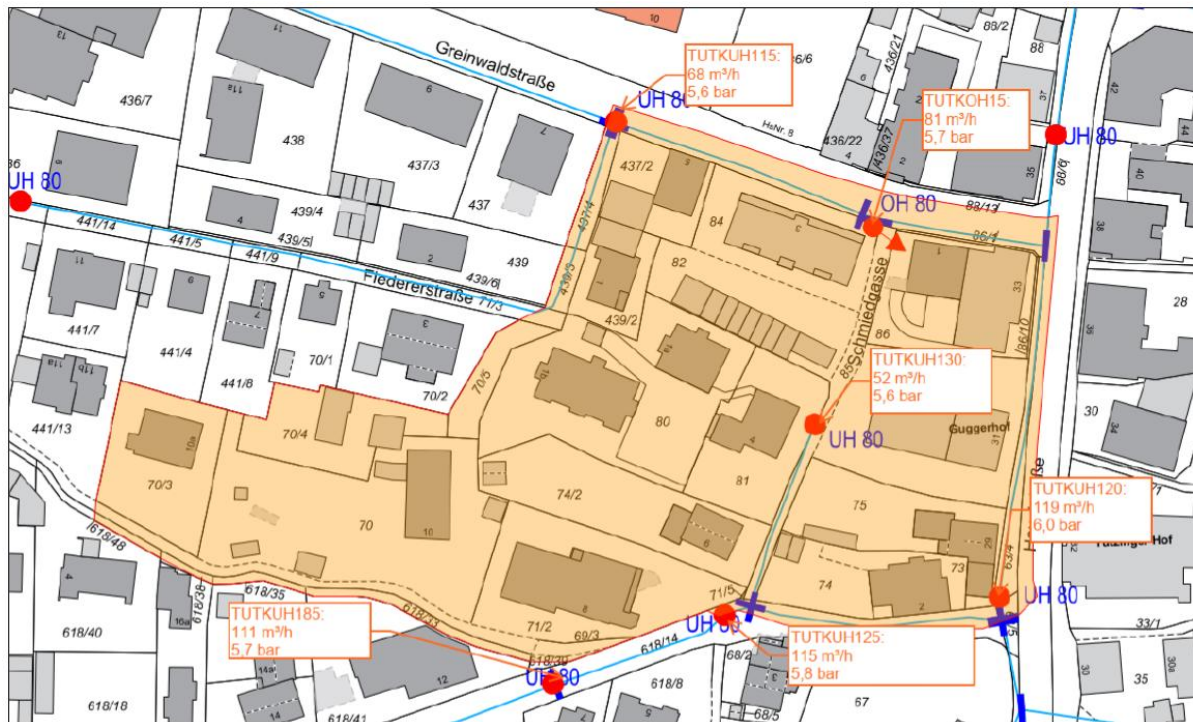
Löschwassermengen und Hydrantenplan , ohne Maßstab, Quelle: Gemeinde Tutzing, Stand April 2025
